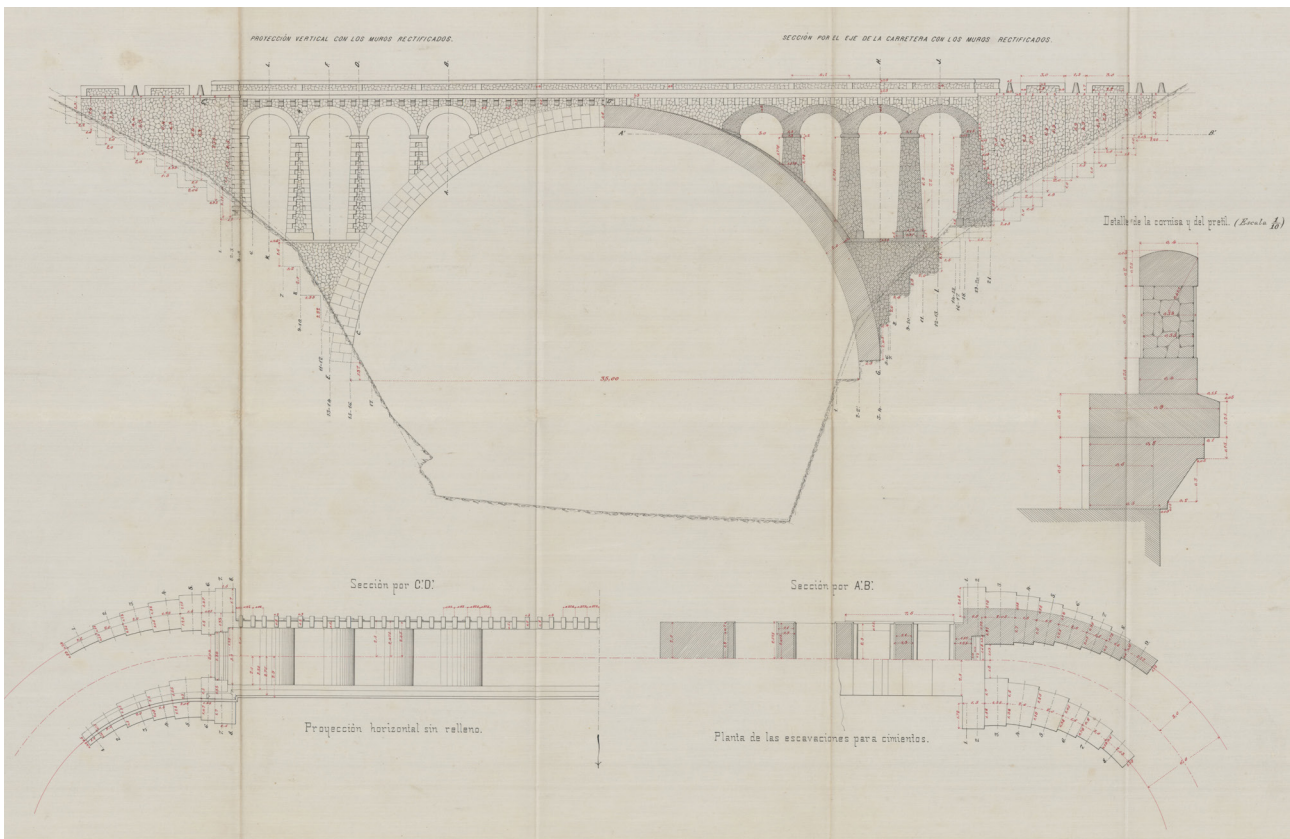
José Peral, alzado del puente sobre el río Cacán, en la carretera de Armilla a Alhama de Granada. Planos del proyecto técnico. 1906. Archivo General de la Administración. Alcalá de Henares. España. Copyright Archivo General de la Administración.
